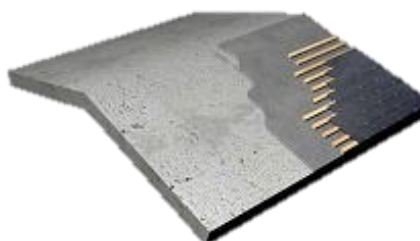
Laje estrutural de uma cobertura inclinada. Fonte: CYPE.
